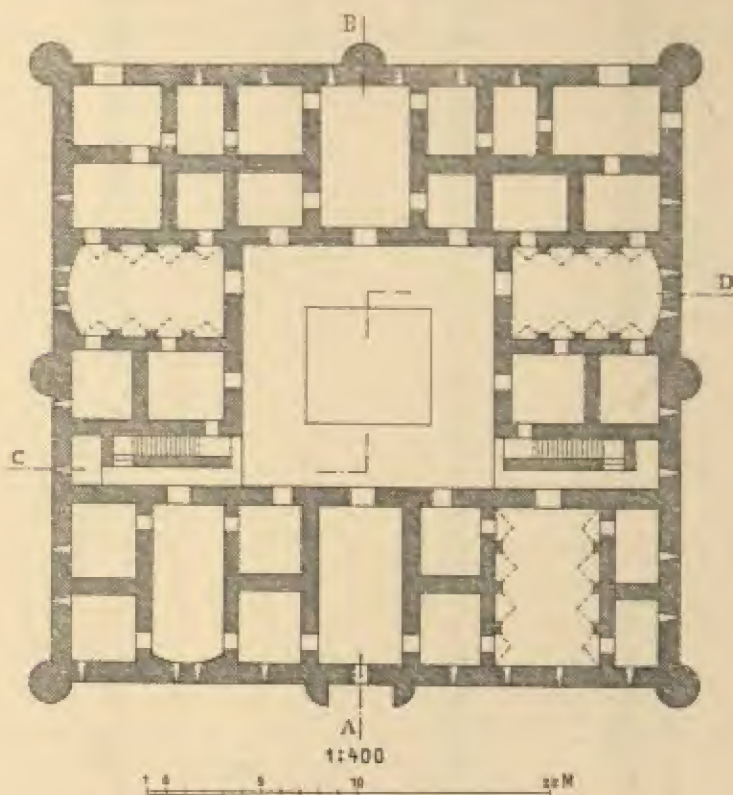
Kaşr al-Ĥarâni. Grundriß des Obergeschosses.
